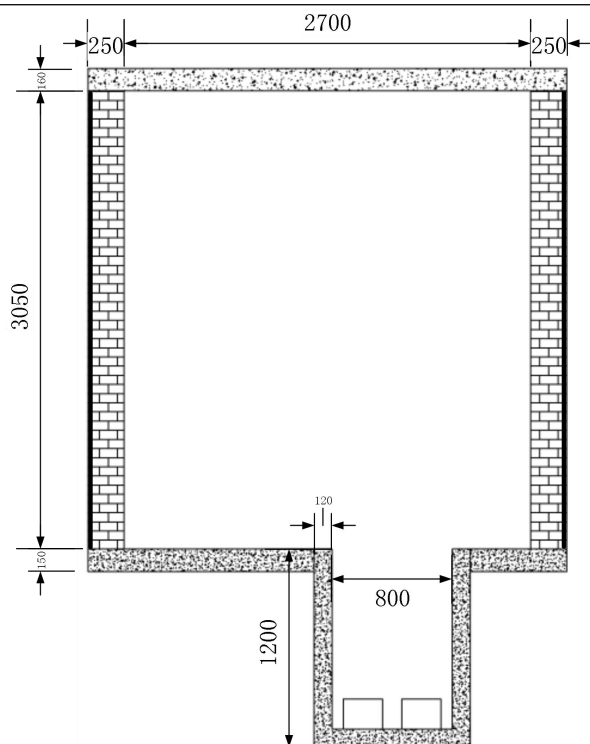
(b) 贮源库1-1剖面示意图(单位: mm)
